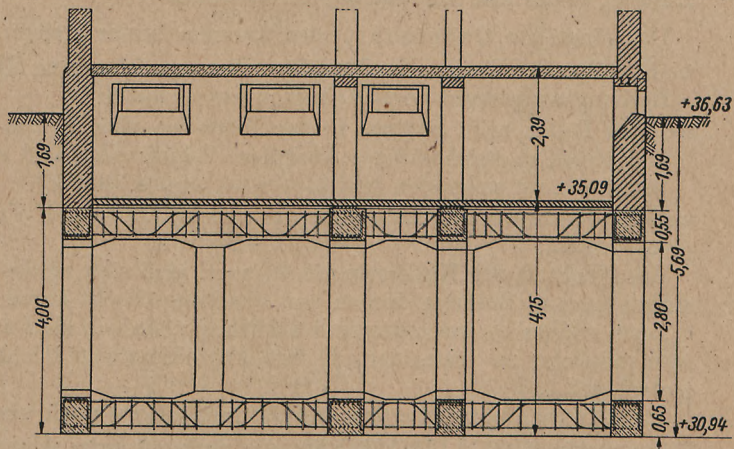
Haus auf Grundpfeilern mit Stahlbetongrundbalken
